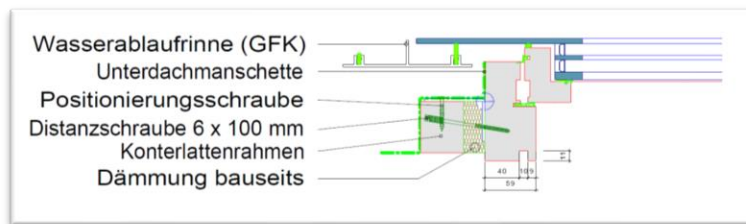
Befestigung MegaSlate Dachfenster mit Distanzschrauben
